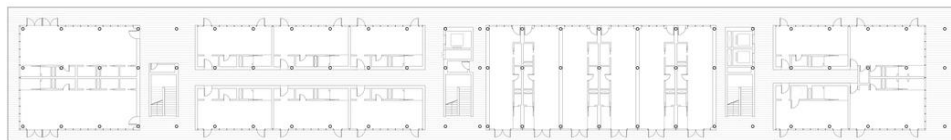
Floating Hotel (Аньцзі, Китай) [1]– план 3-го поверху
